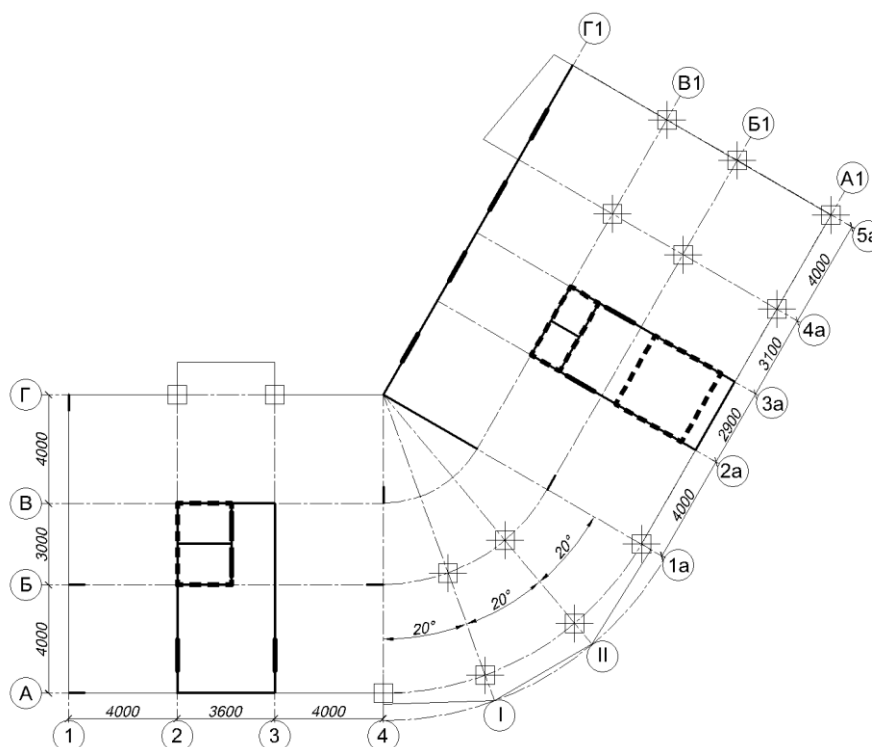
Плита перекрытия типового этажа с отверстиями
